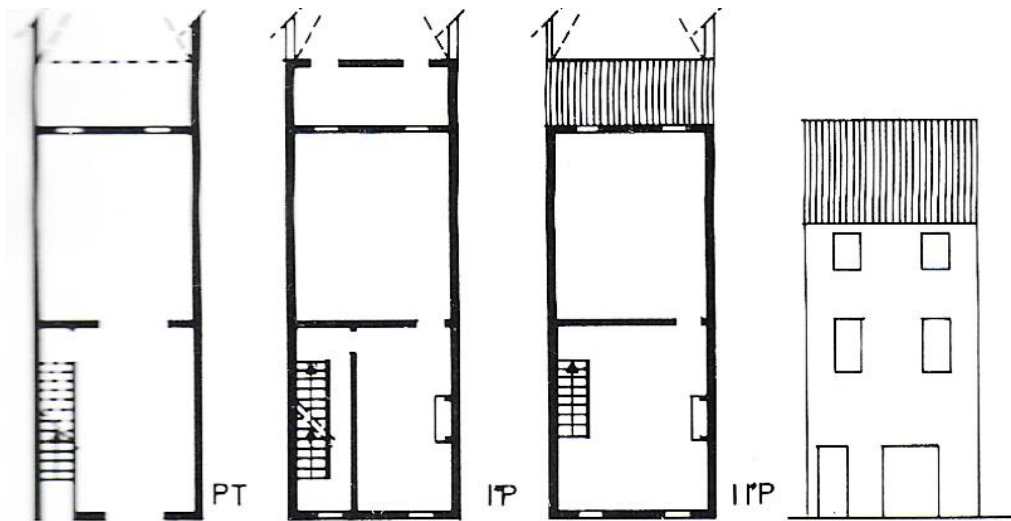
Plantas y alzado casa adosada a tienda plurifamiliar.
